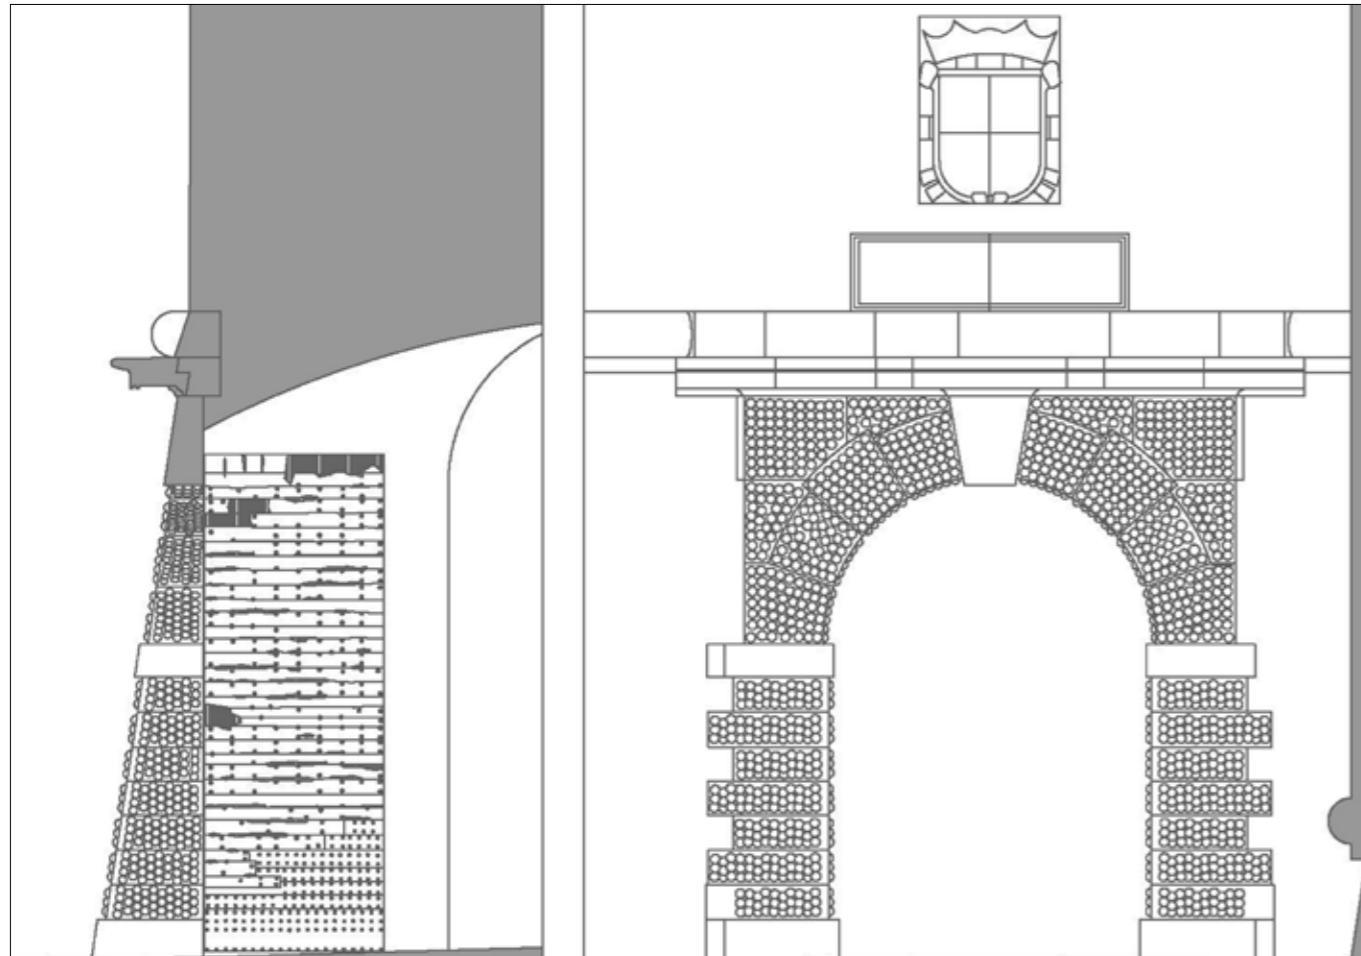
Sección y alzado de la portada. Proyecto de restauración. (Balaguer 2010).
